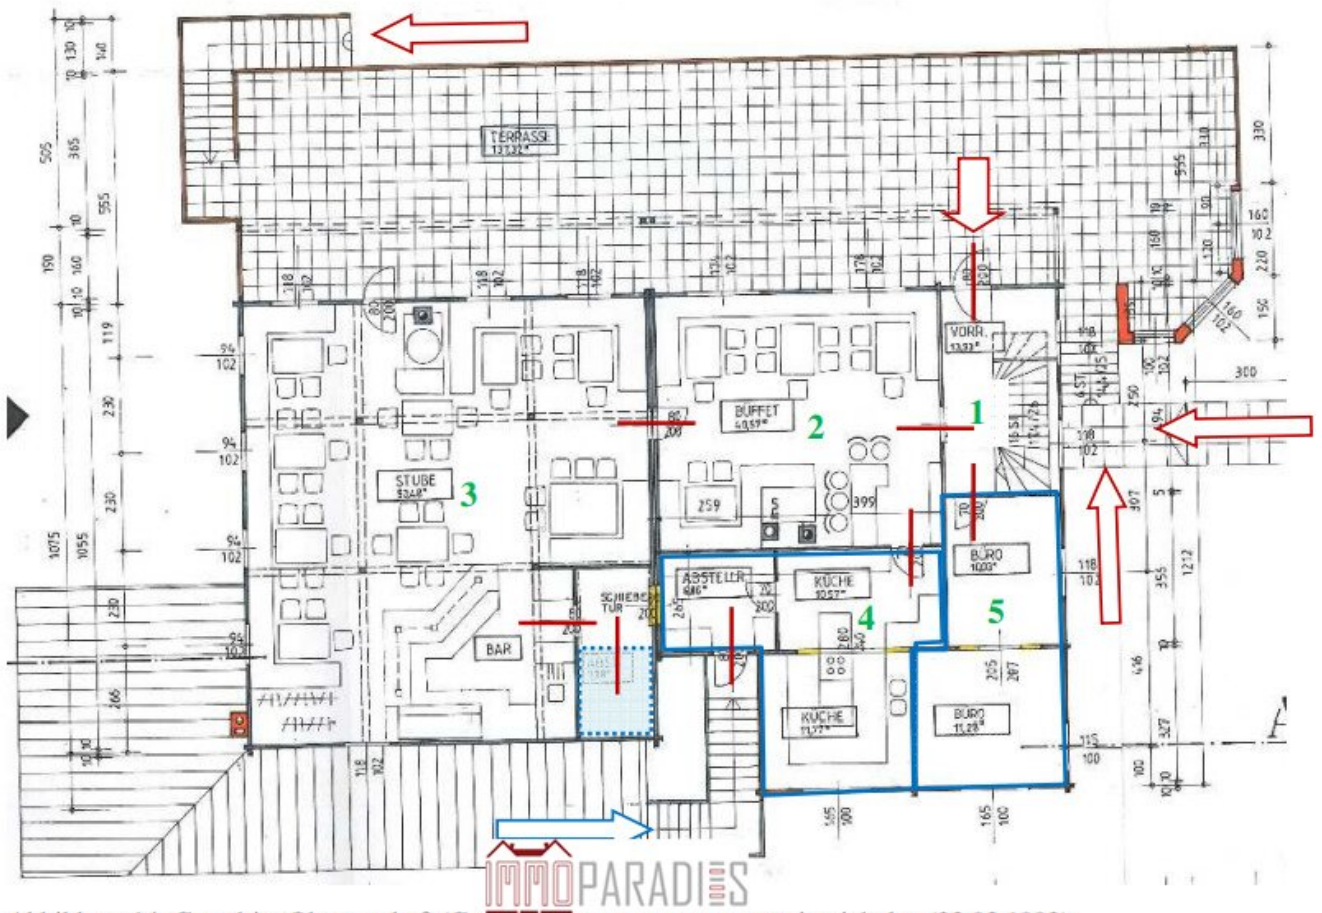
Grundriss Obergeschoß (Gastronomie); Quelle: Gesamteinreichplan (22.02.1992)
